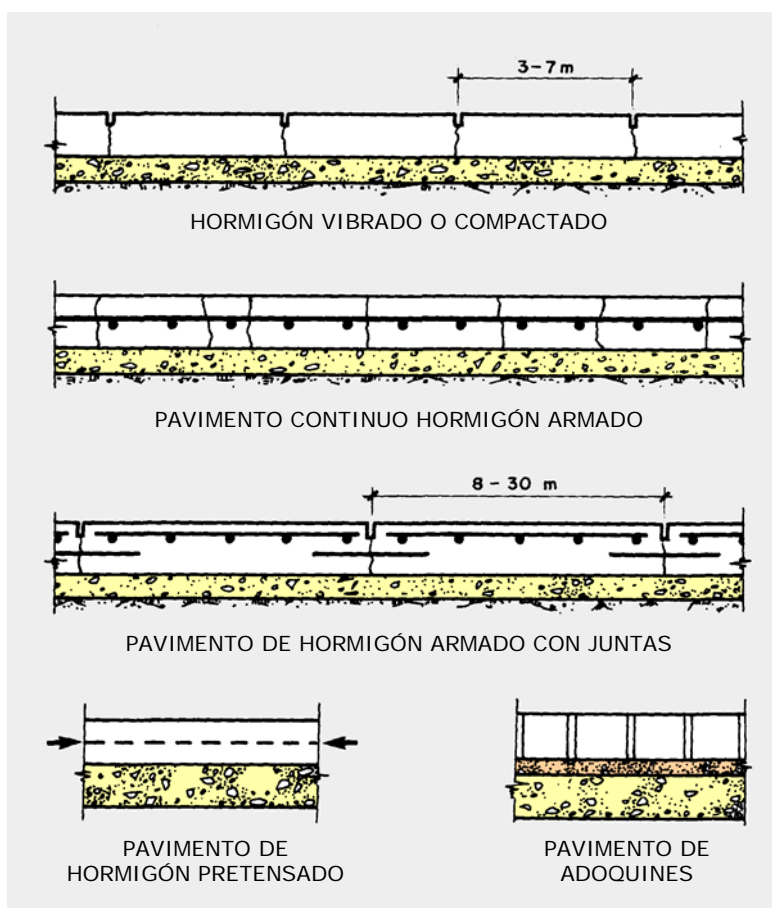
Pavimentos empleados en firmes rígidos
